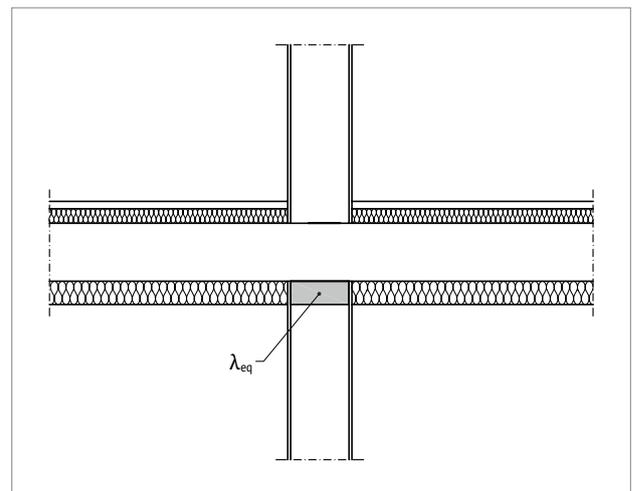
Darstellung einer Schnittzeichnung mit vereinfachtem Ersatzdämmkörper
